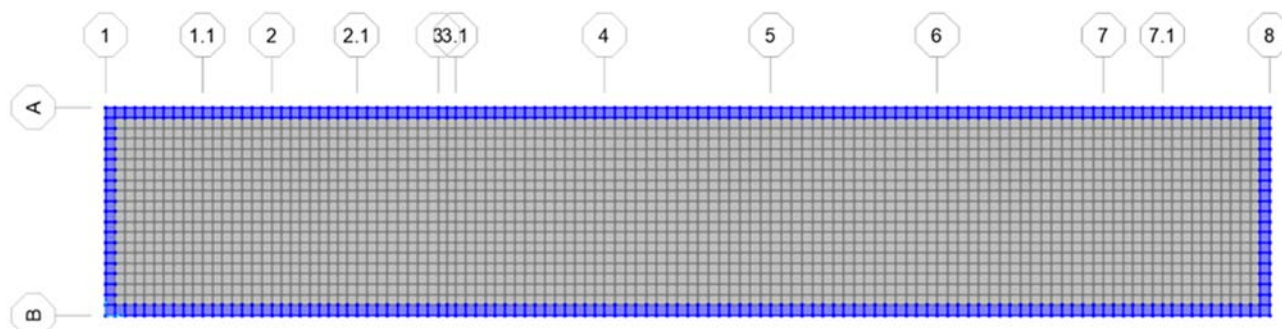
Pianta del modello di analisi della platea di fondazione – numerazione elementi shell
